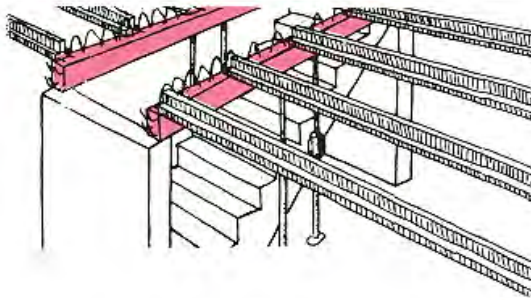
Perímetro de cubo de escalera donde sólo se soporta un extremo de losa de vigueta y bovedilla.
